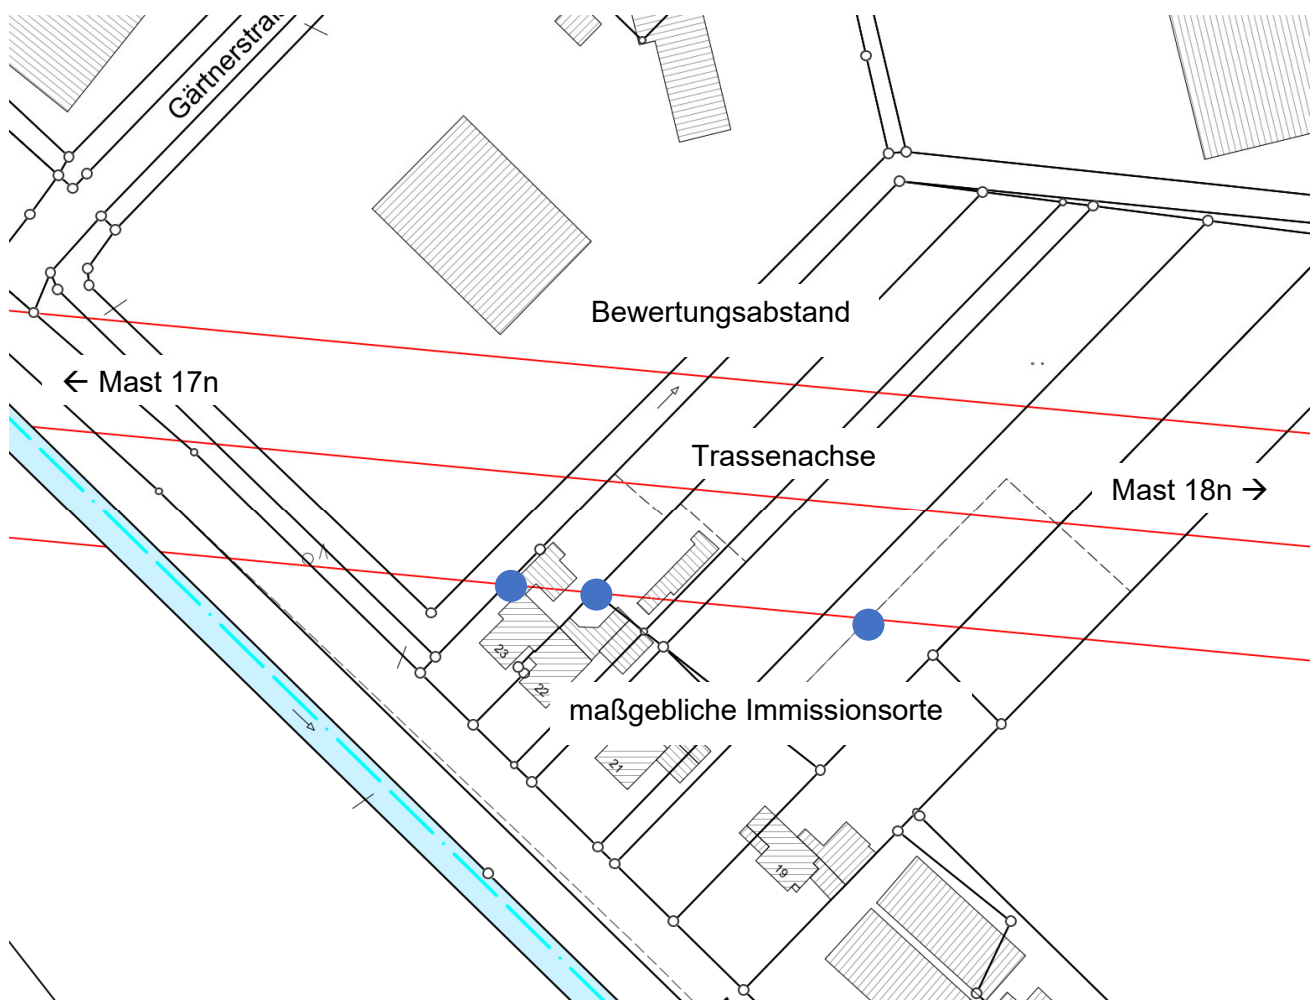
Lageplan Ersatzneubau Leitung LH-14-067 mit 10 m Bewertungsabstand (rot) für Immissionsberechnung mit den ermittelten maßgeblichen Immissionsorten (blau)
